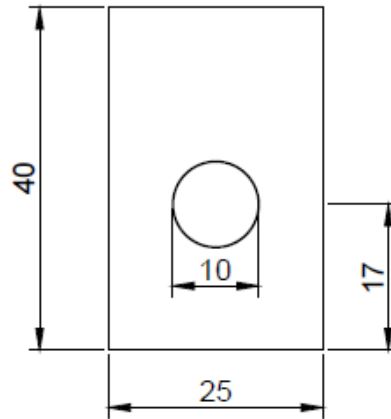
Sección de la viga de concreto con refuerzo de bambú
